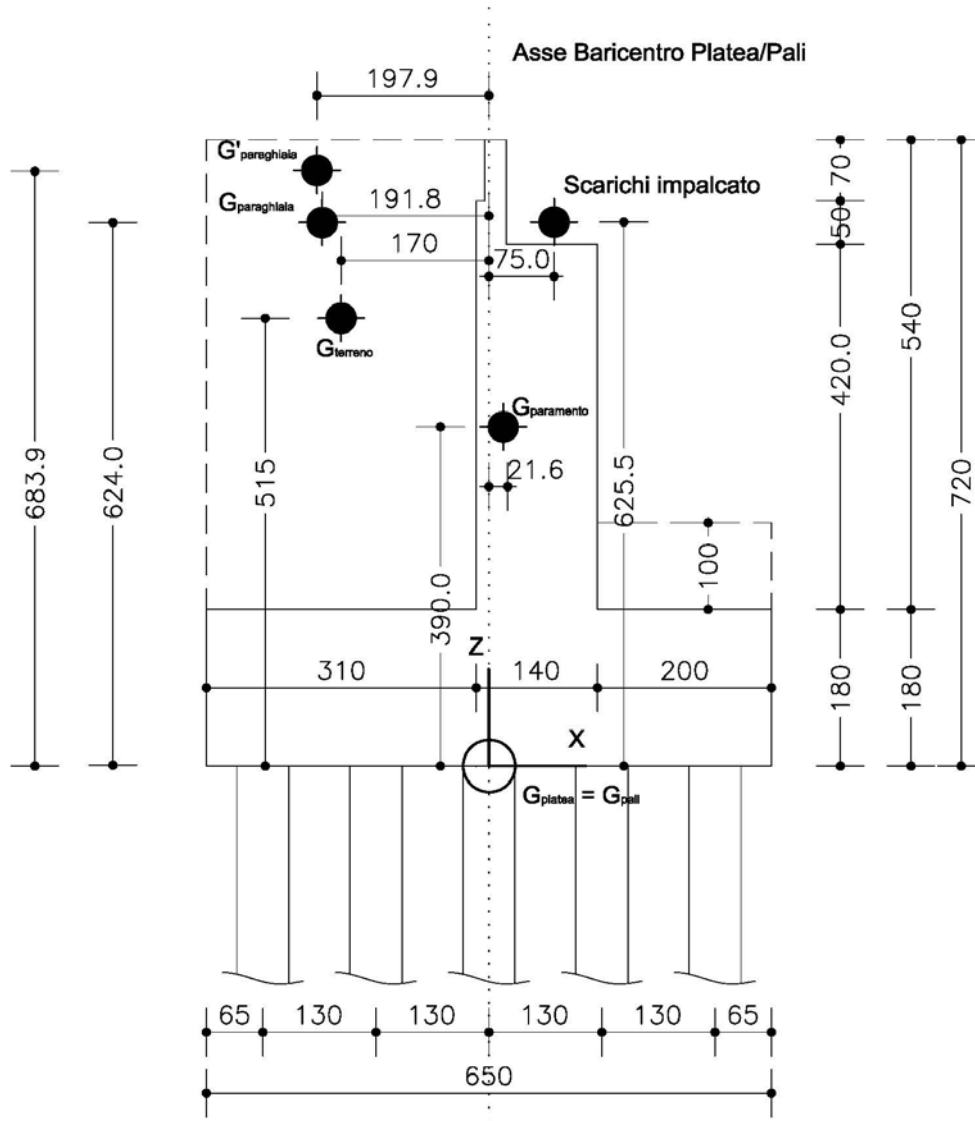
Geometria di calcolo delle spalle nello stato di fatto
